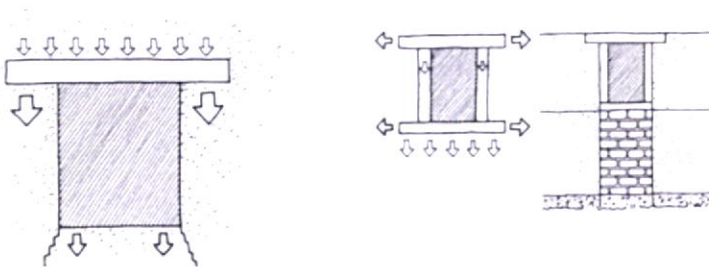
Esquema da distribuição de forças junto ao vão de uma janela exterior e pormenor de execução do vão para eliminar o surgimento de fissuras.
